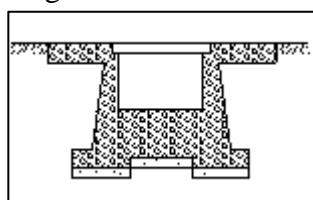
Drainase Segi Empat Beton bertulang Tertutup
